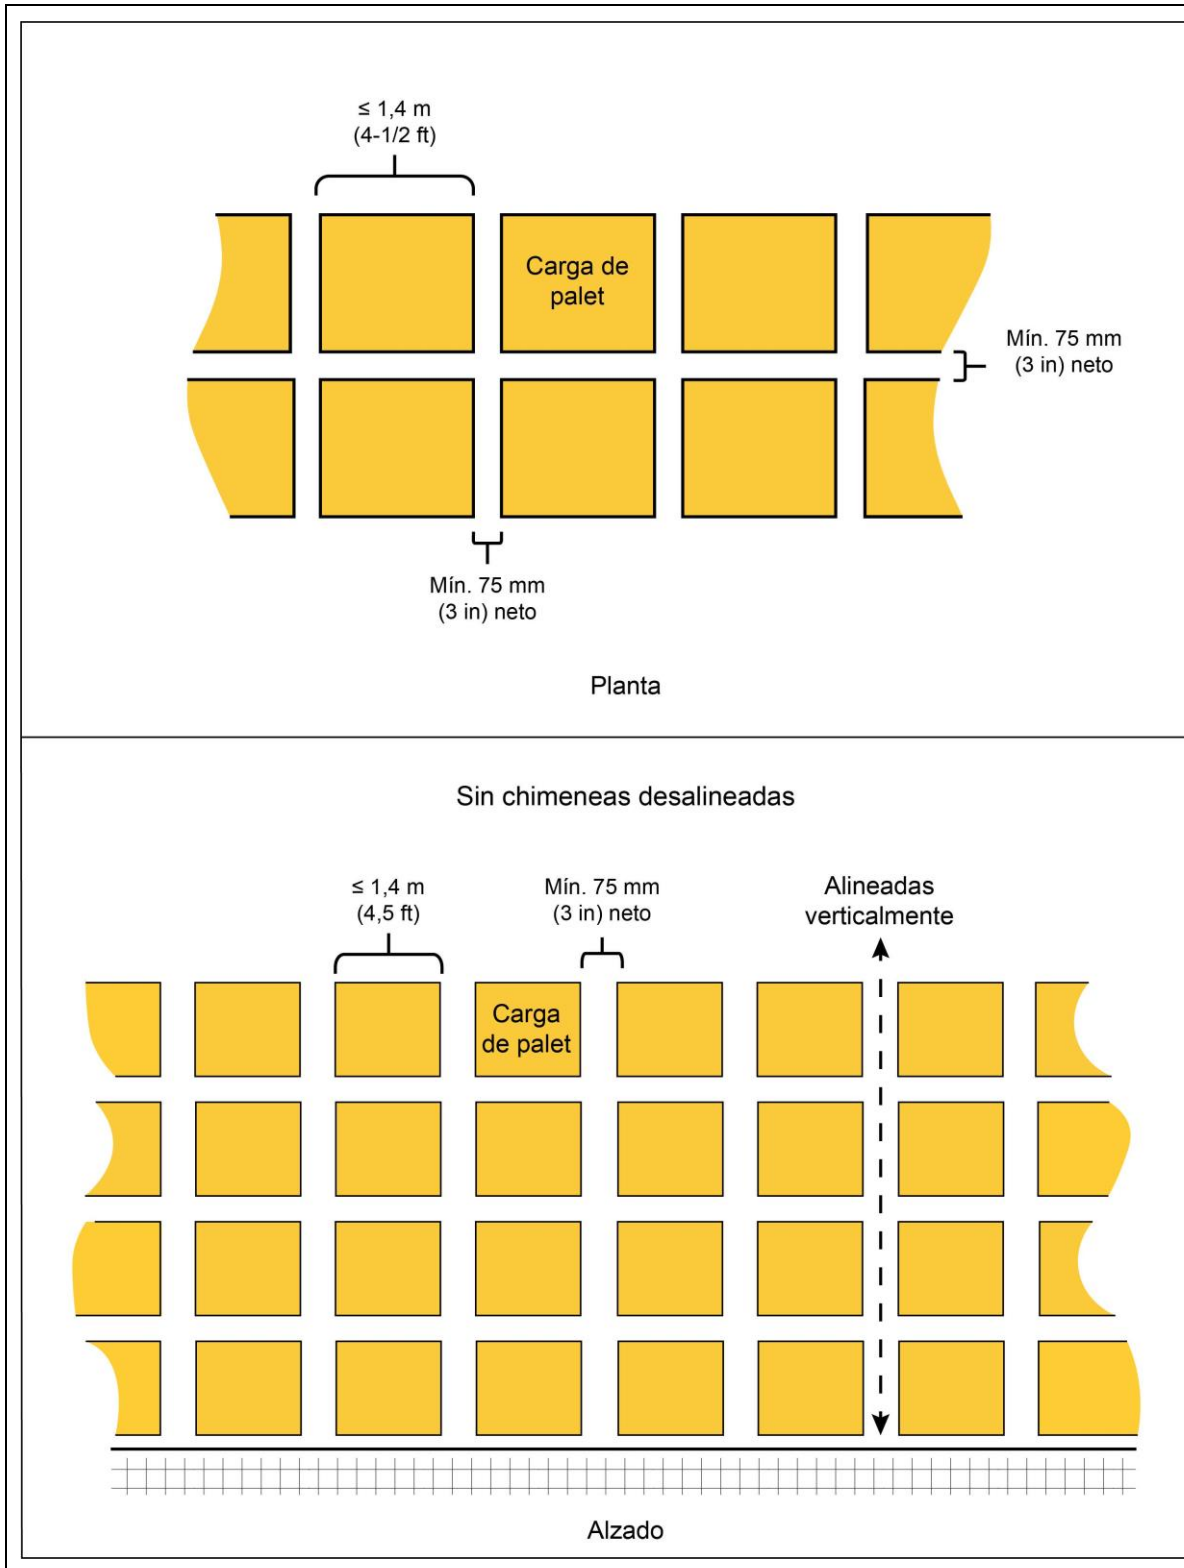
Configuración aceptable de las chimeneas para estanterías dobles, Opción 1
